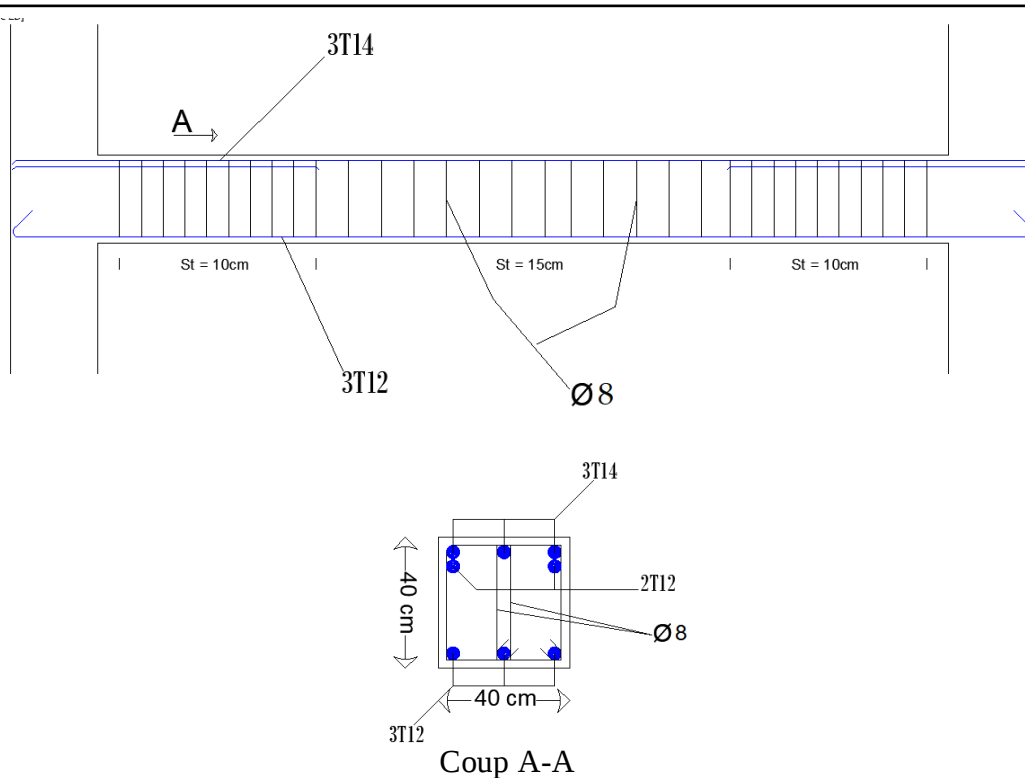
Schéma de ferrailage des poutres principales (Etage).
